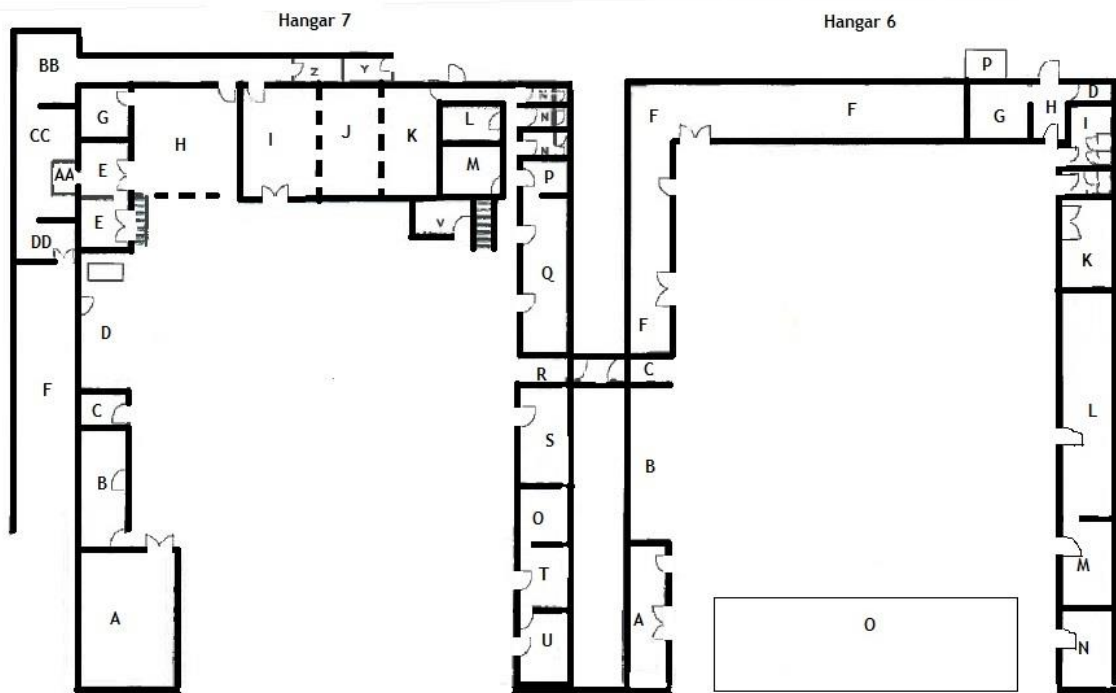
Instalações da Aerotécnica (Plantas Gerais).
